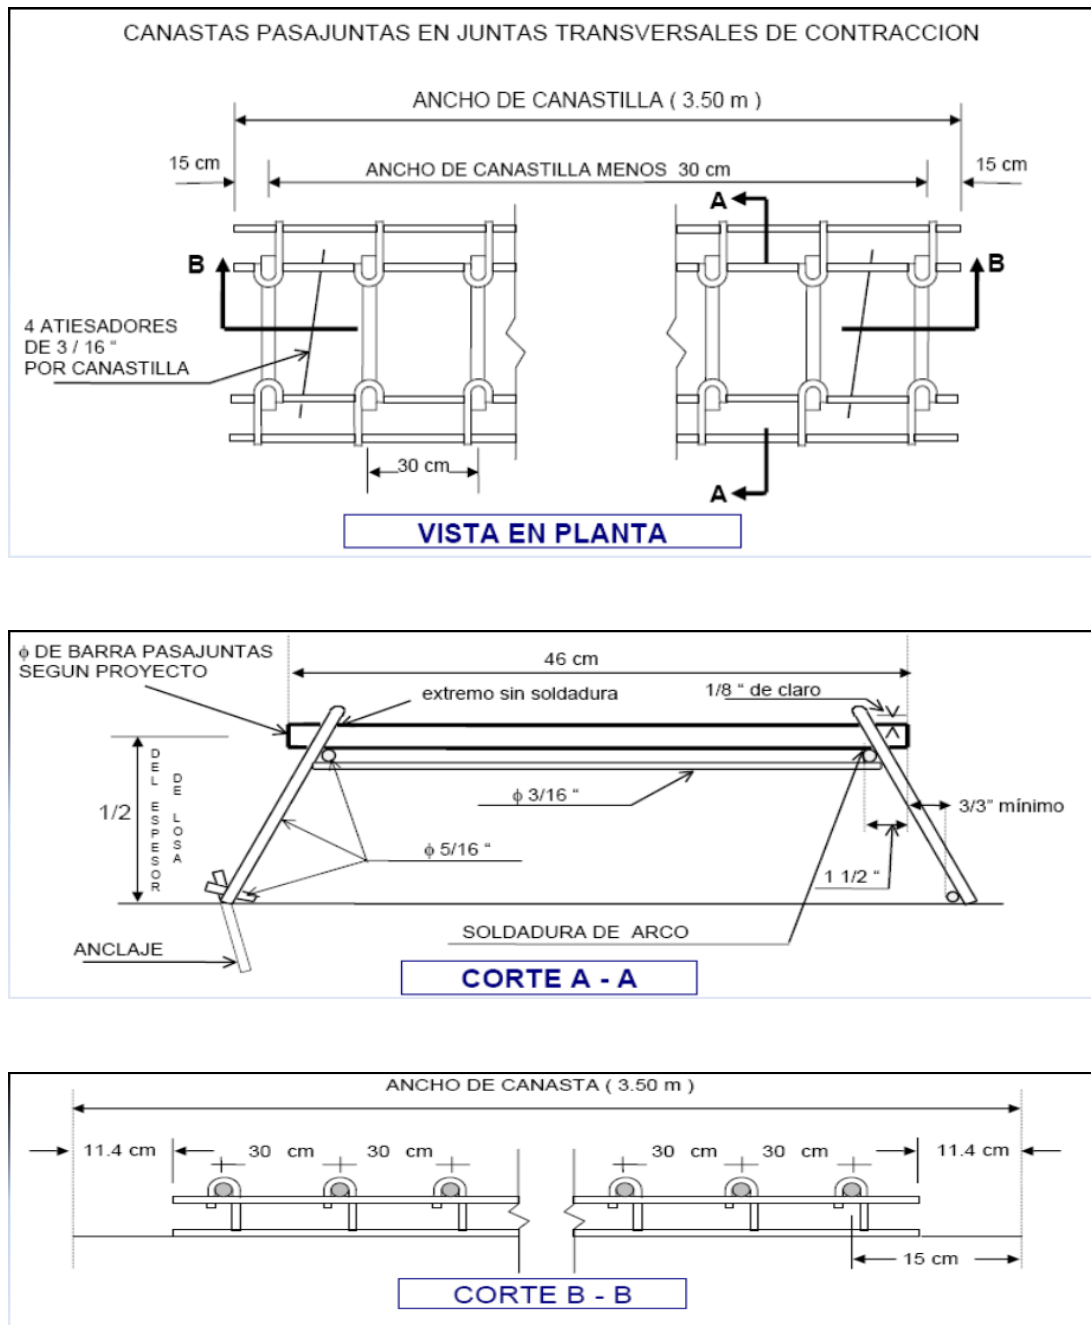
Canastas Pasajuntas En Juntas Transversales De Contracción
